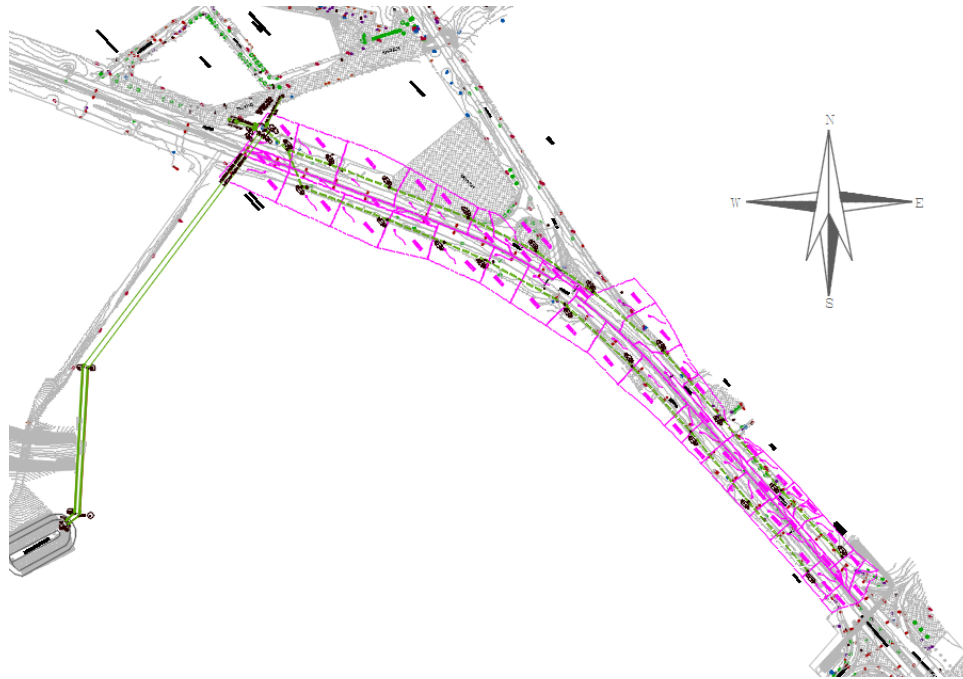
Planta general de localización de las estructuras proyectadas/existentes.
